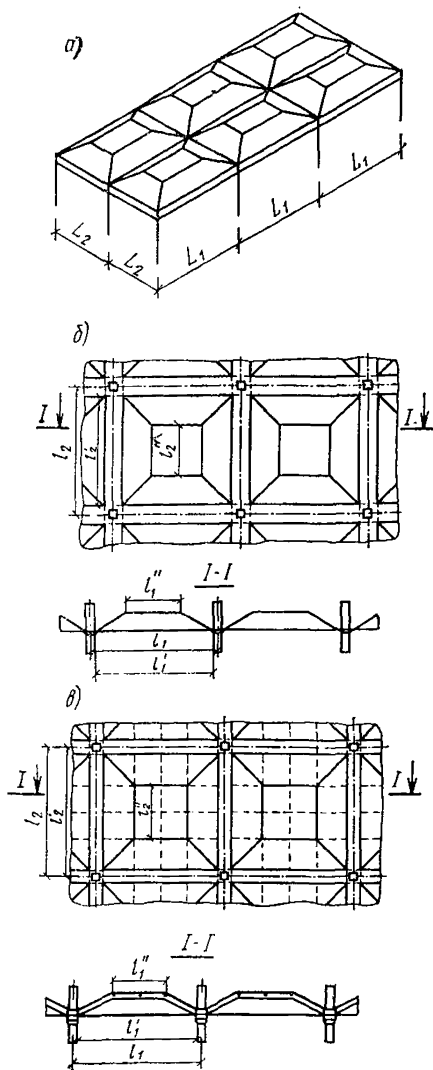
Схемы шатровых складок перекрытий и покрытий
